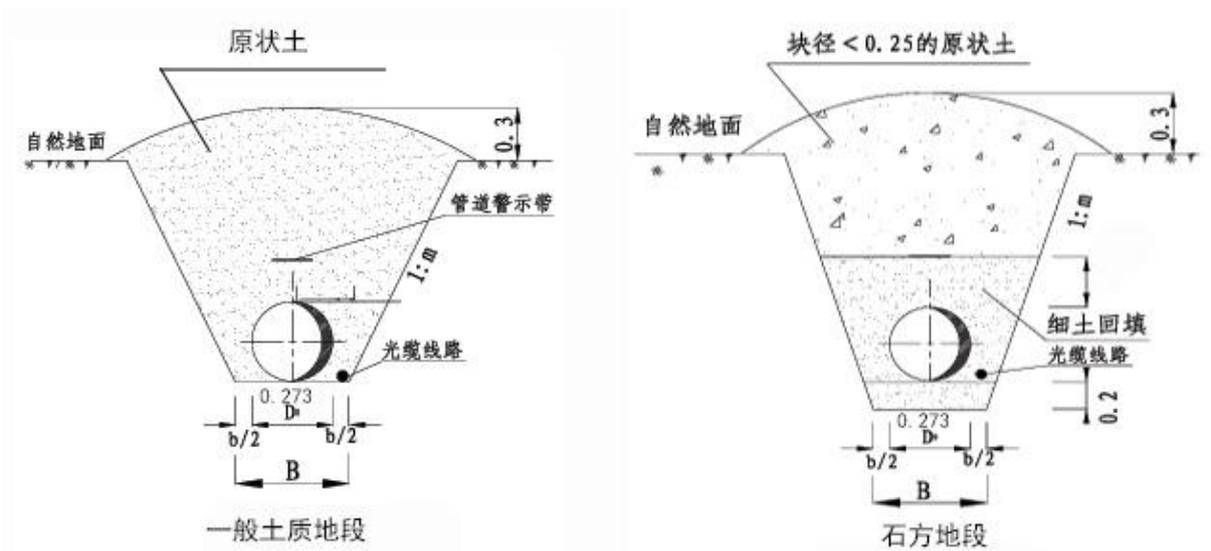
一般地段管道断面示意图（埋管后，深度<5m）
